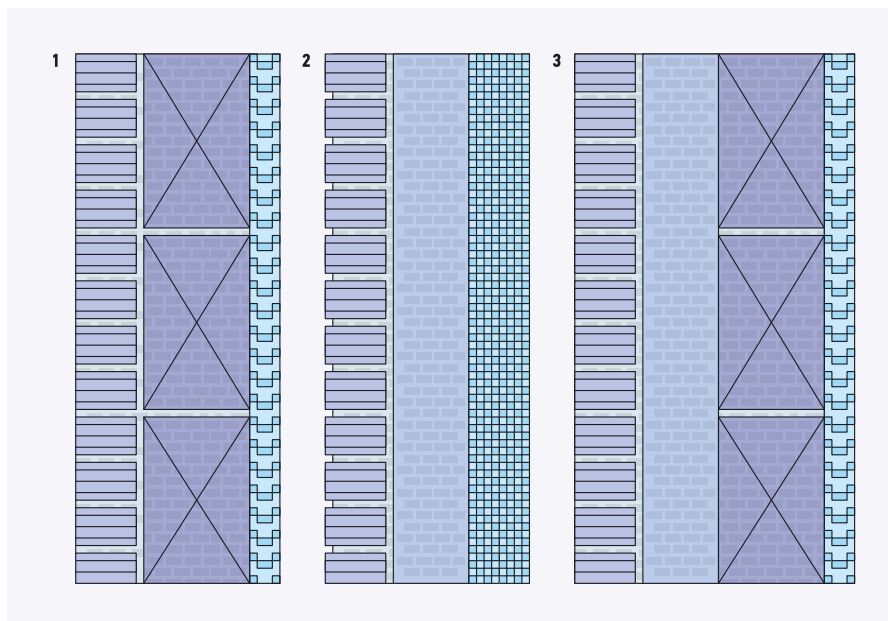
Схемы конструкций стен с облицовкой из кирпичной кладки (1 — штукатурка внутренняя поверхность, кладка из ячеистобетонных блоков, кладка из лицевого кирпича; 2 — железобетонная стена, эффективный утеплитель, кладка из лицевого кирпича; 3 — штукатурка внутренней поверхности, кладка из ячеистобетонных блоков, эффективный утеплитель, кладка из лицевого кирпича)
